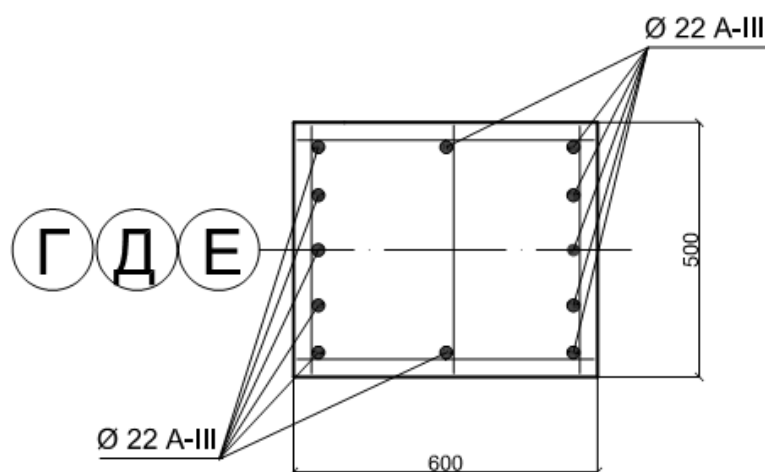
Схема армування збірних залізобетонних колон 500×600 мм крайніх рядів по осі «Г», «Д» та «Е»
